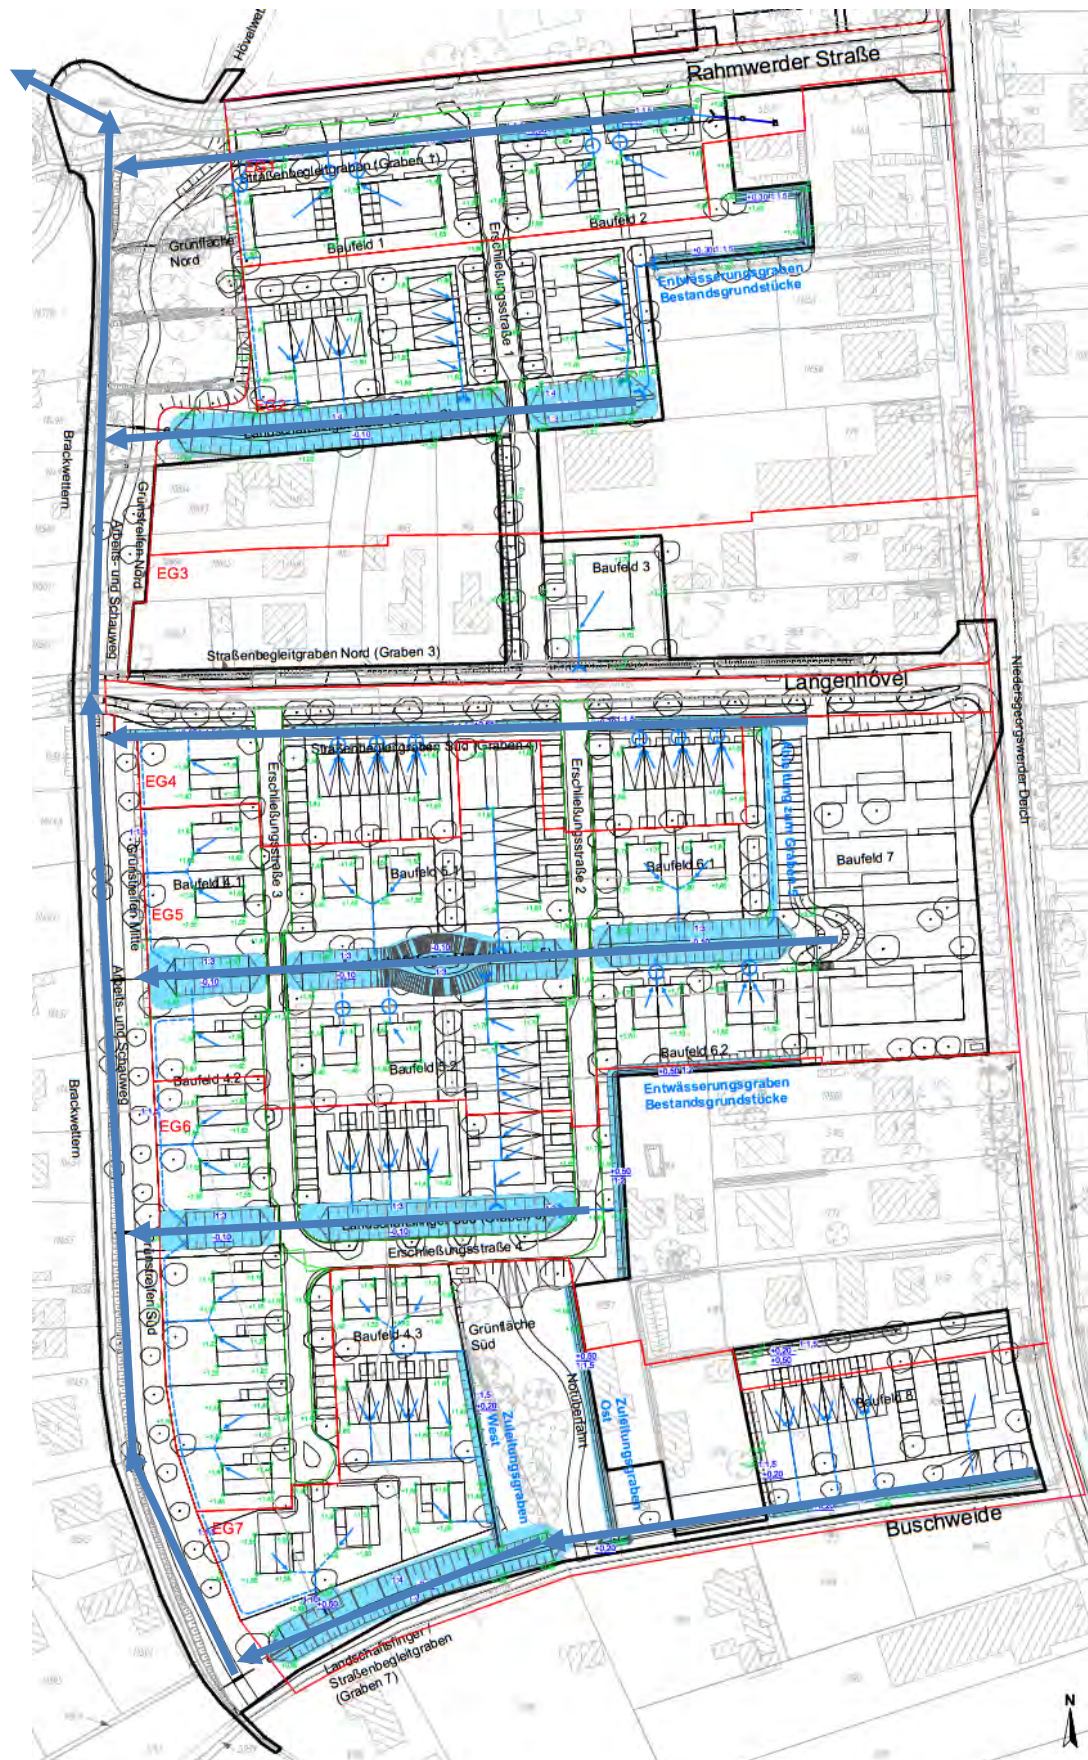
Lageplan mit dem Entwässerungssystem im Plangebiet
